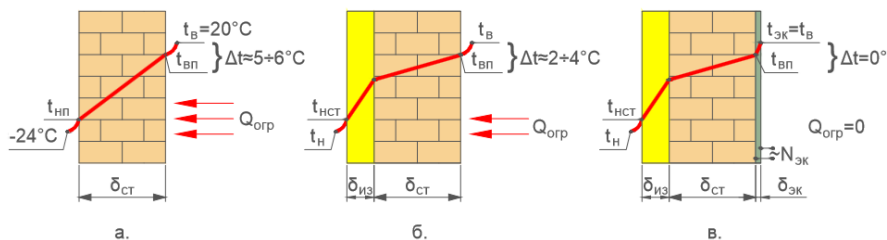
Графики изменения температуры воздуха и наружной стены: а - в исходном состоянии; б - с фасадным утеплением; в - с фасадным утеплением и теплозащитным экраном
